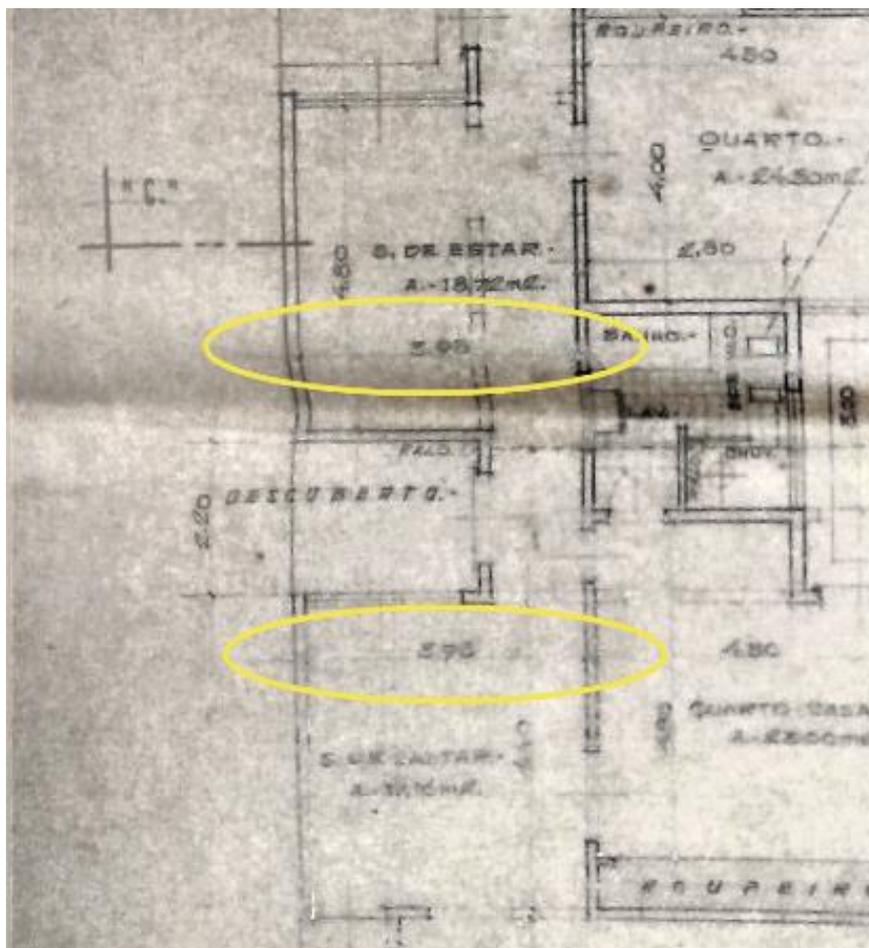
Detalhe da Planta baixa da casa Maria Deolinda. Fonte: Acervo LAHCA.
